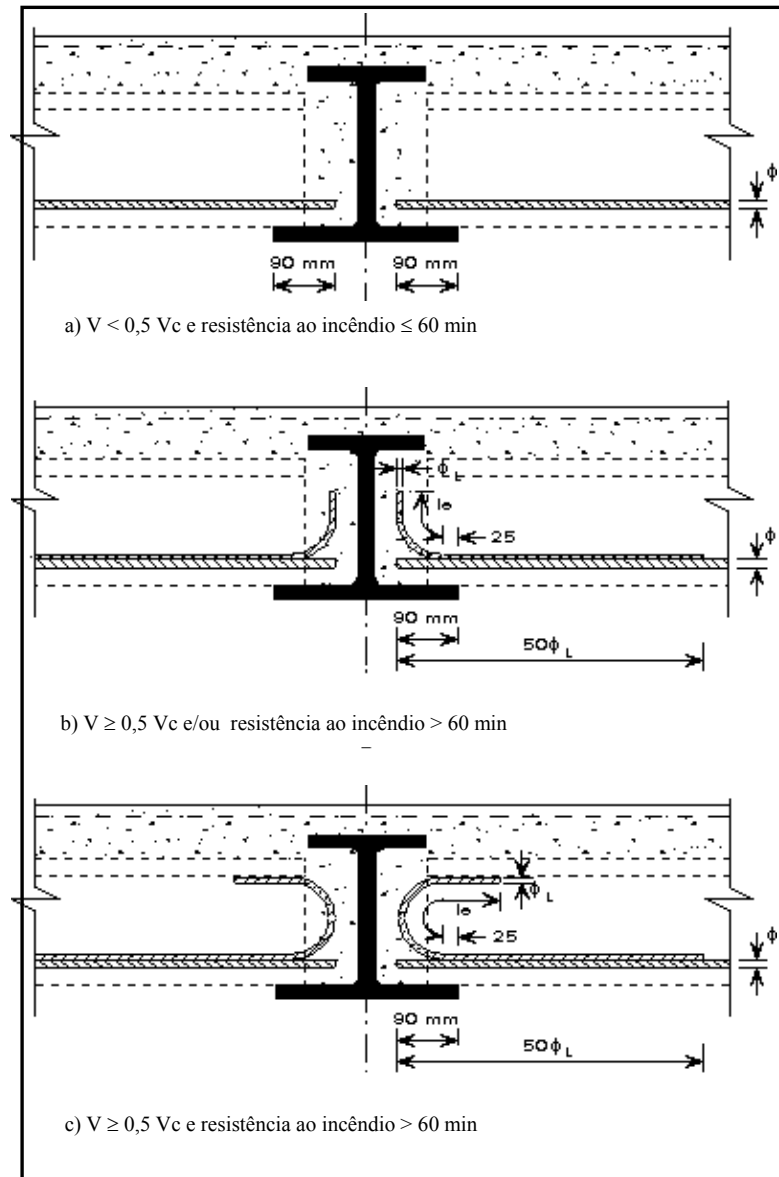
Detalhes da ancoragem da armadura de tração
